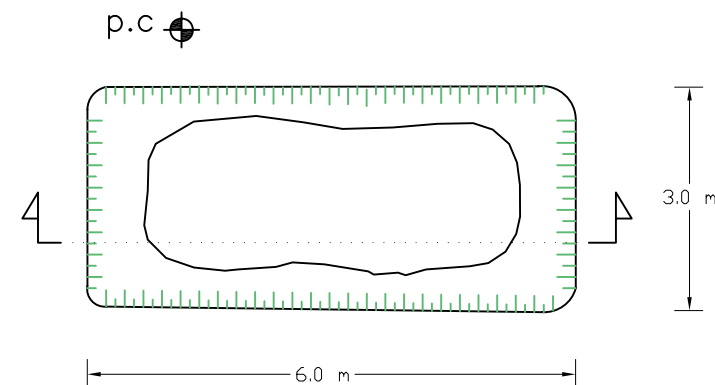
SCHEMA PLANIMETRICO E SEZIONE DELLE TRINCEE
